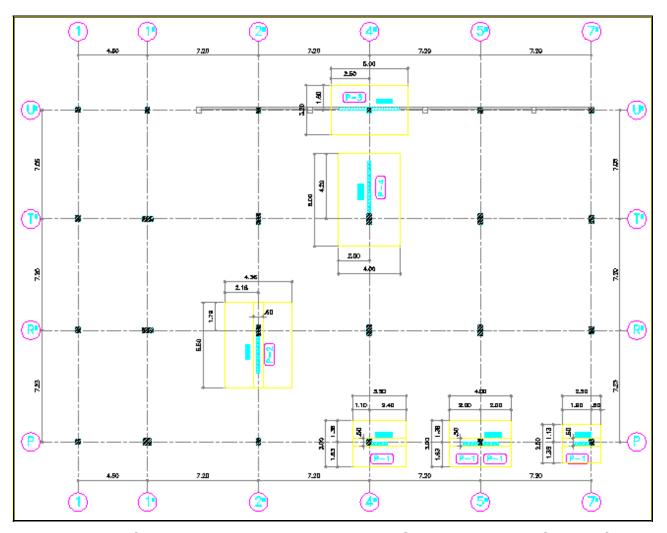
Reforzamiento Existente Primer Piso. Sector 8. Hospital San José
